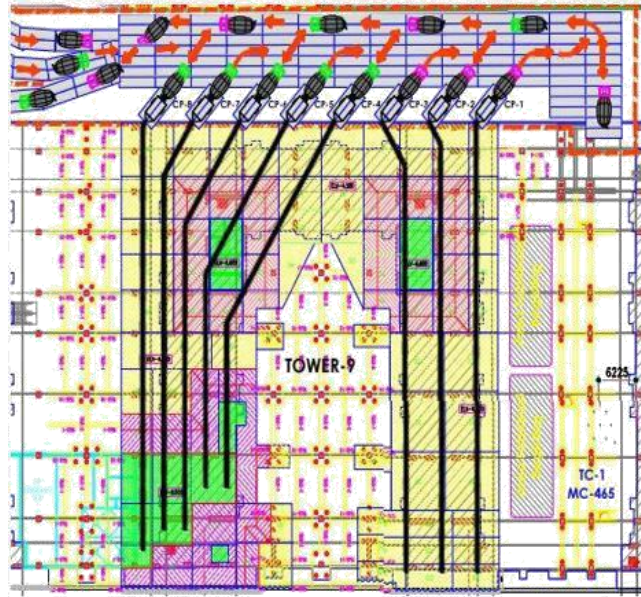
Layout Perencanaan Pengecoran Tower 9
